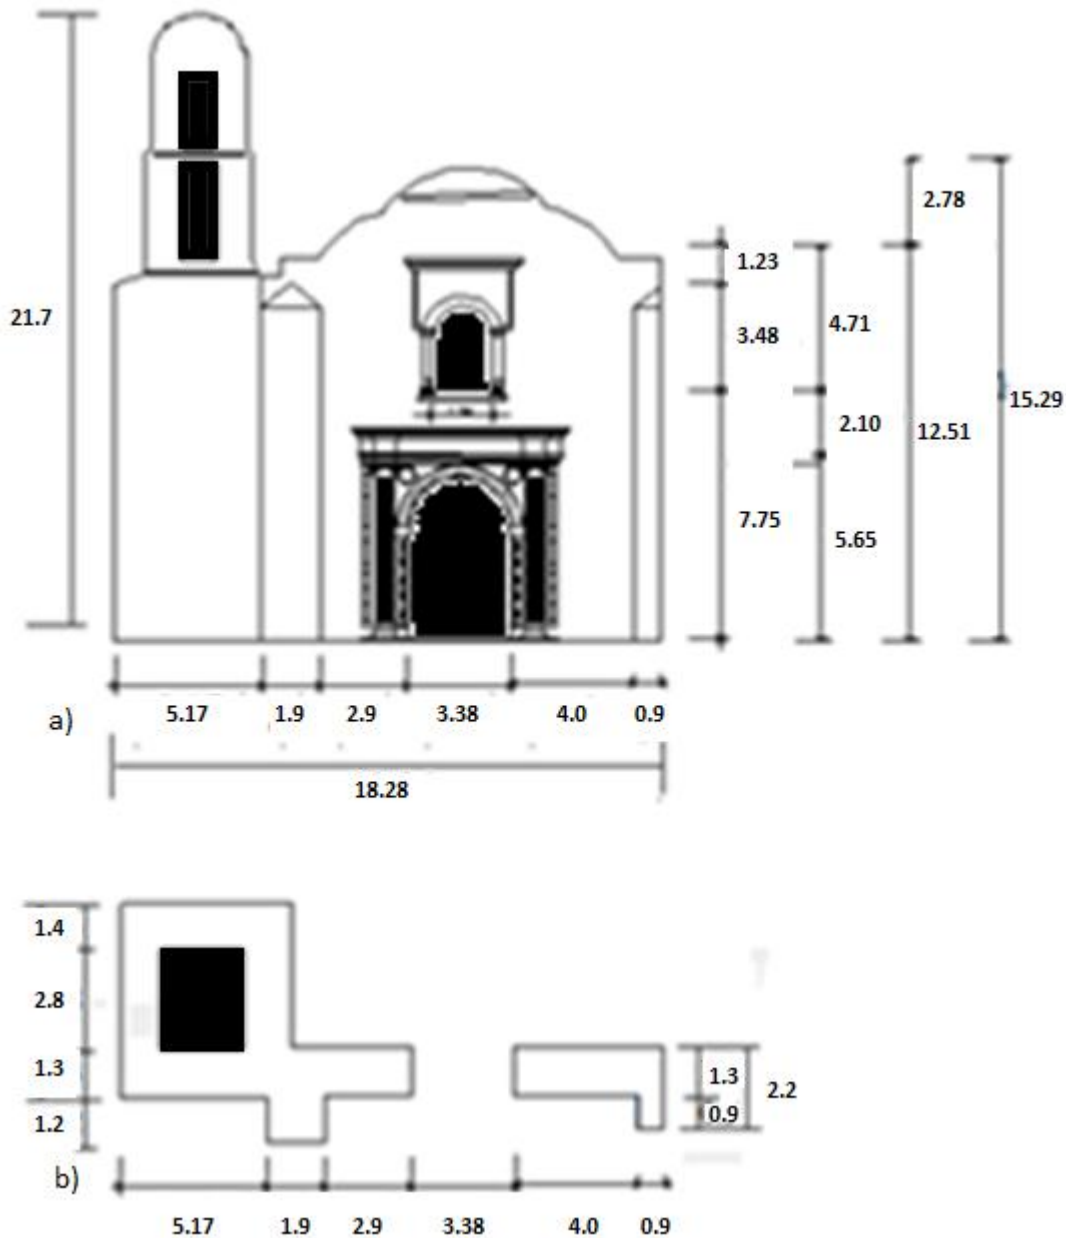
Geometría de la fachada de la Parroquia de Santiago Apóstol (dimensiones en m)
